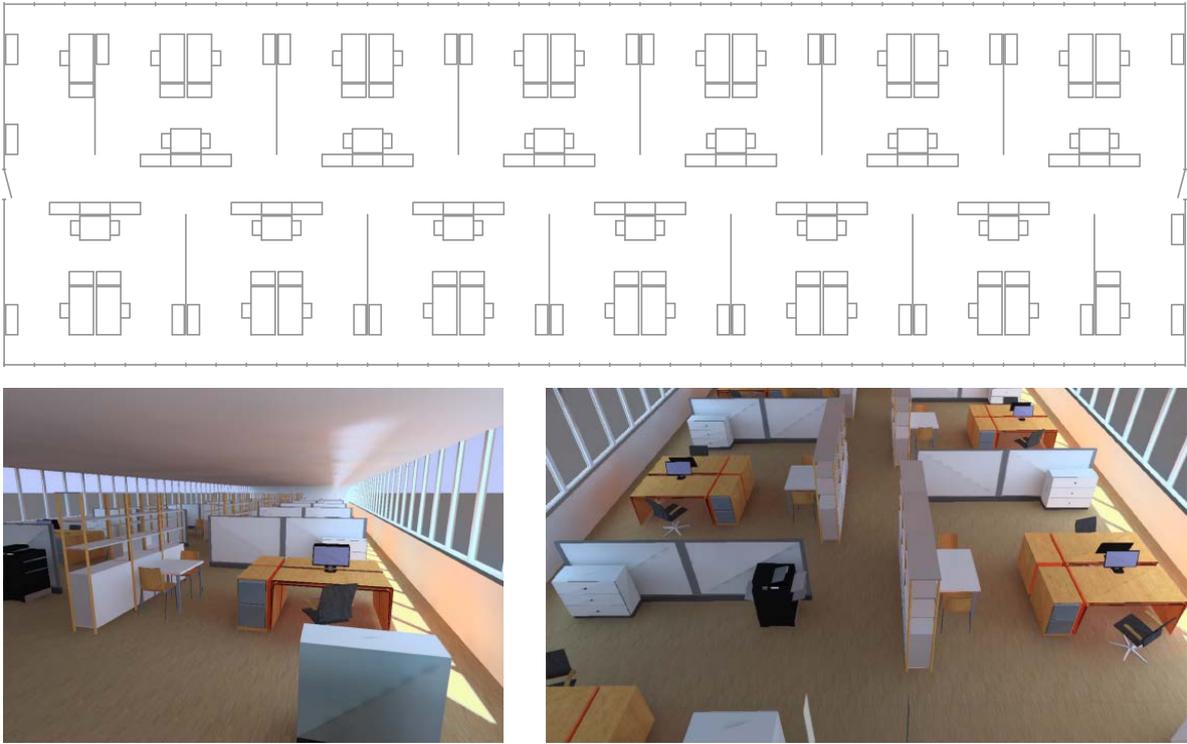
Grundriss und Rendering Großraumbüro
